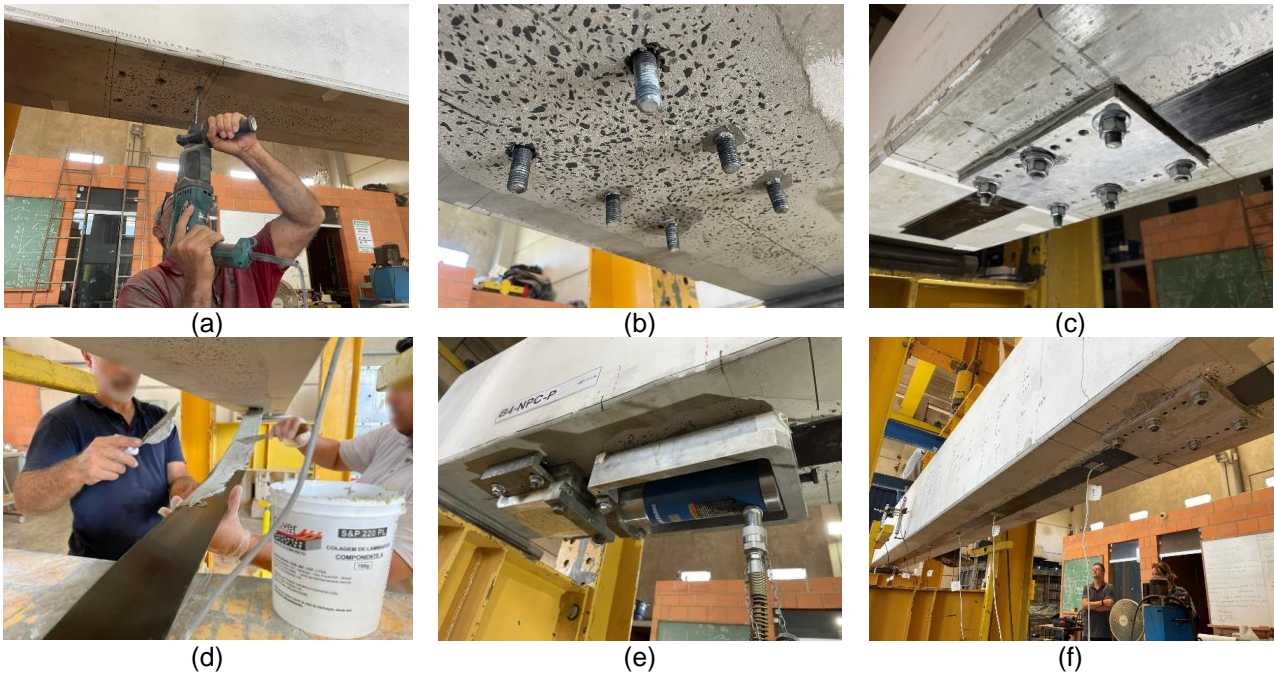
Aplicação do sistema de reforço com laminado de CFRP protendido (Autores)
